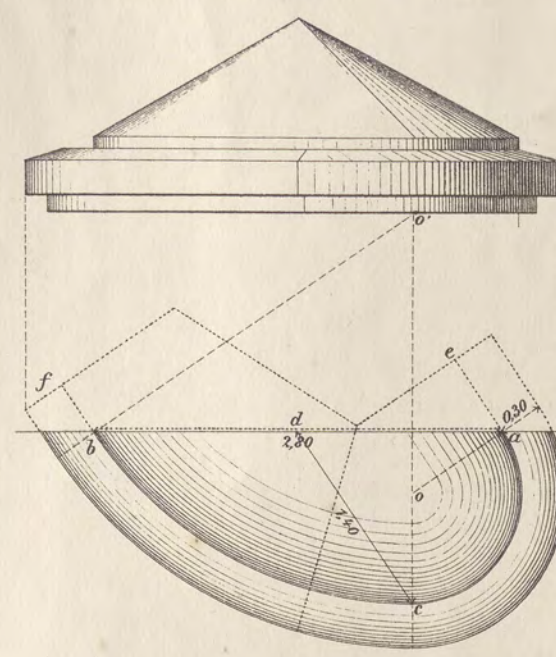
<sup>a</sup> Semi-cappuccio dalla parte dell'angolo ottuso di una spalla.
